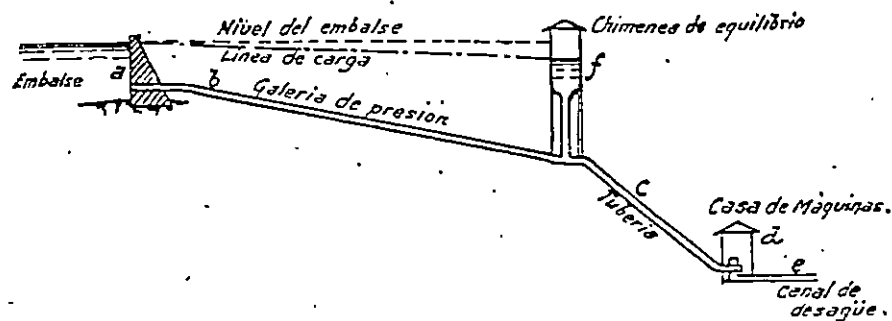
Salto con presa de embalse, galería de presión, chimenea de equilibrio, tubería casa de máquinas y canal de desagüe.
